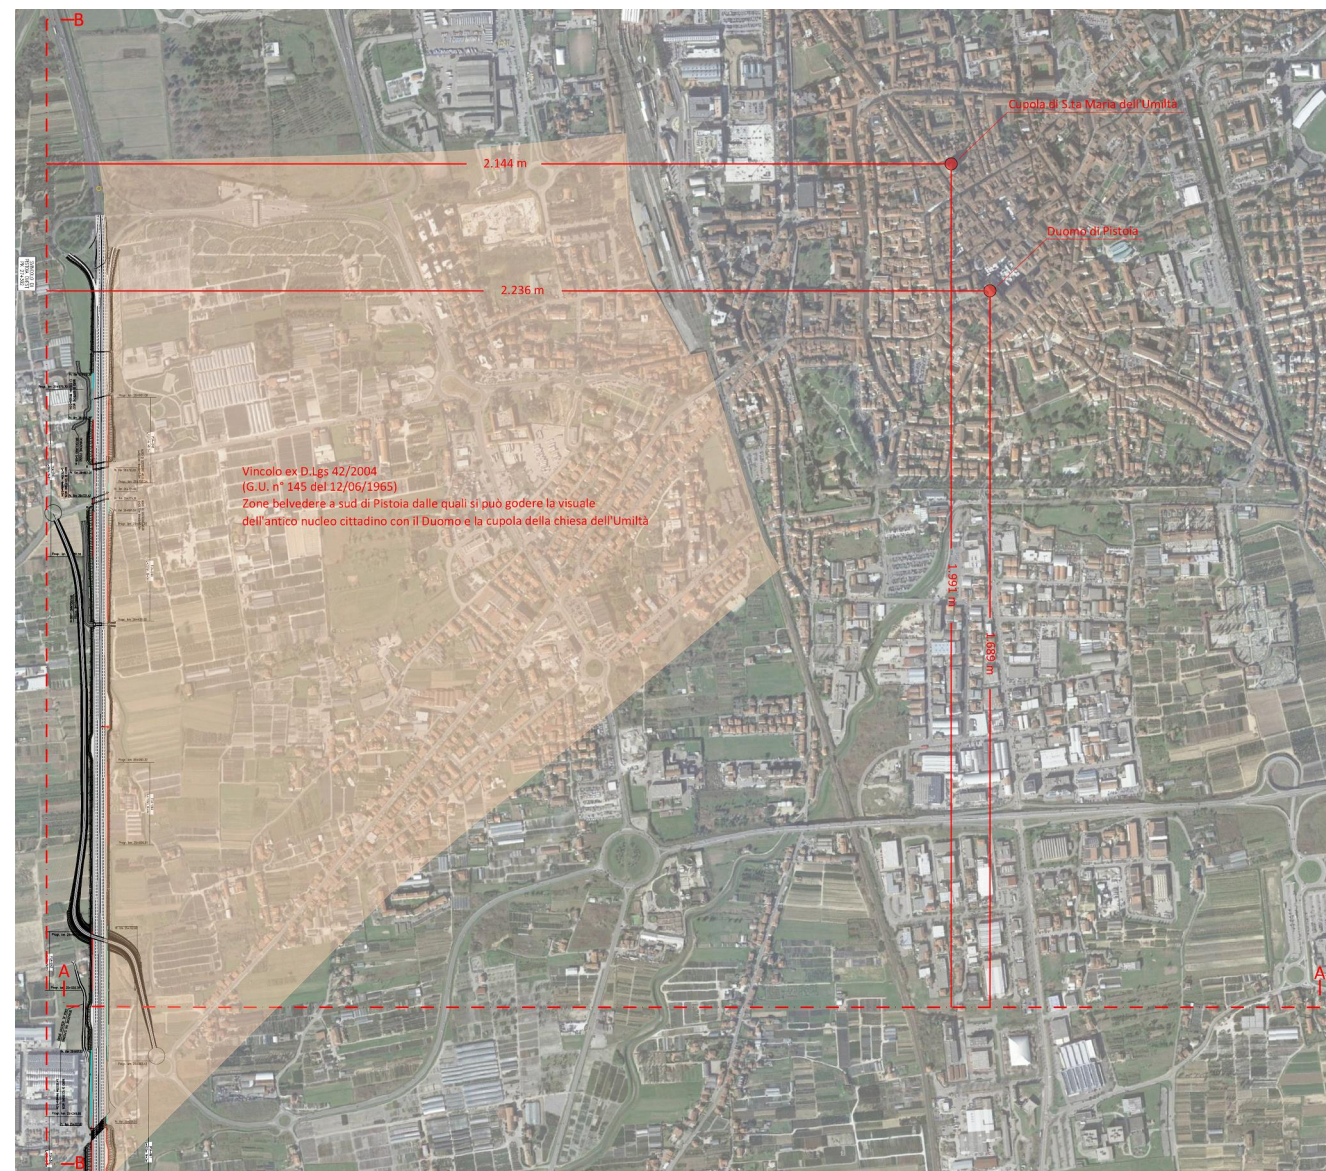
Tracciato di progetto e indicazione delle sezioni A - A e B - B
